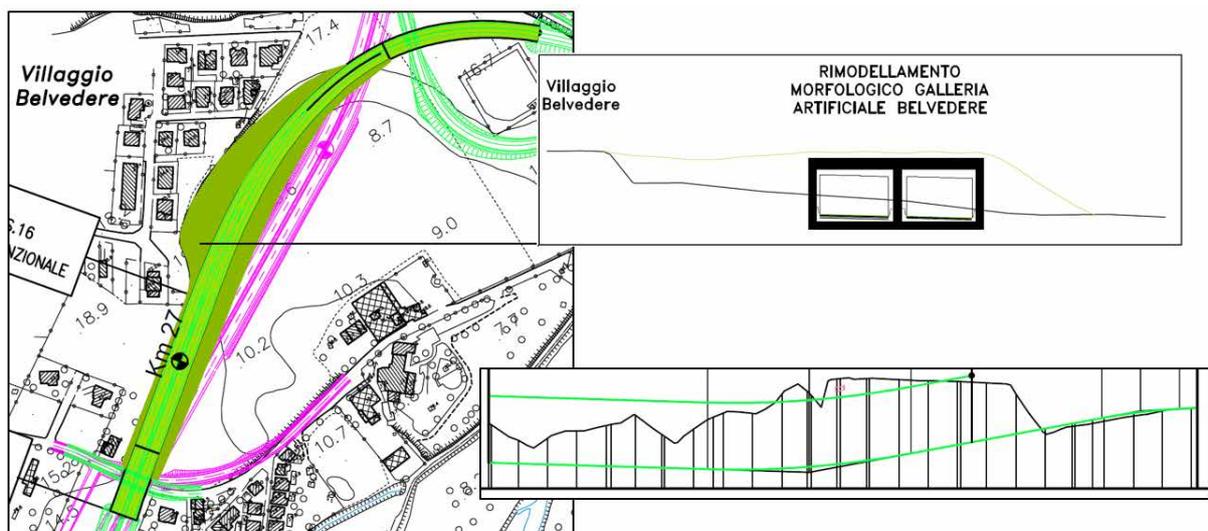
Stralcio planimetria e sezioni dell'intervento tra pk 26+850 e pk 27+460
